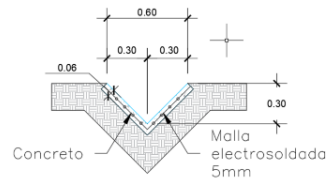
Sección de cuneta a construir en el PMRRA Ladrillera Alemana
